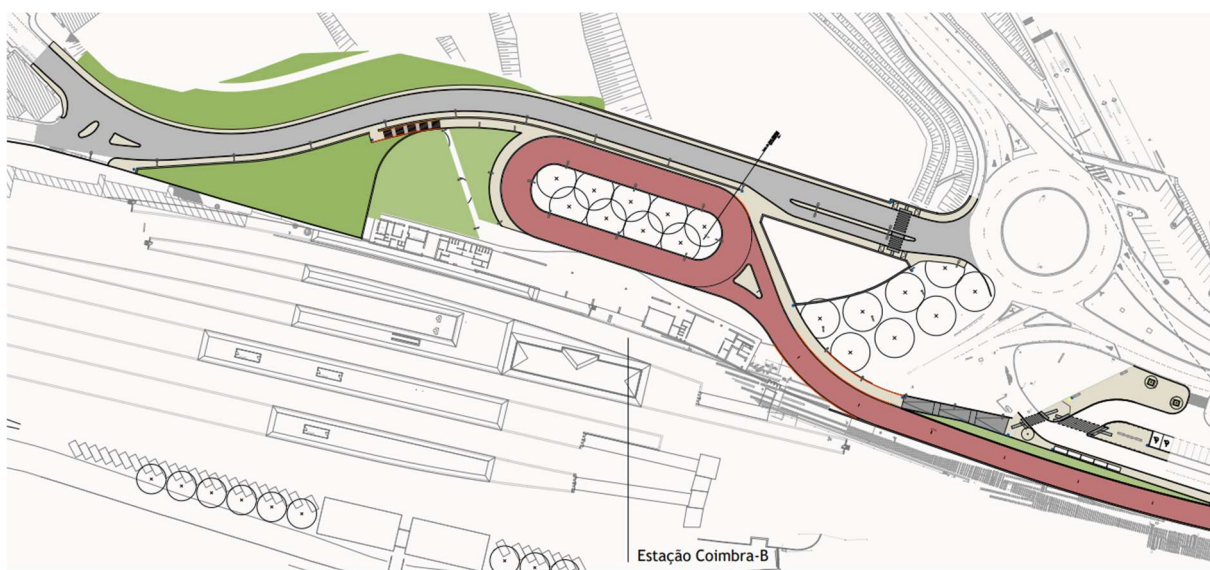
Vista em planta da futura paragem de Coimbra B (Fonte: Infraestruturas de Portugal, IP Engenharia, Profico (2020f))
